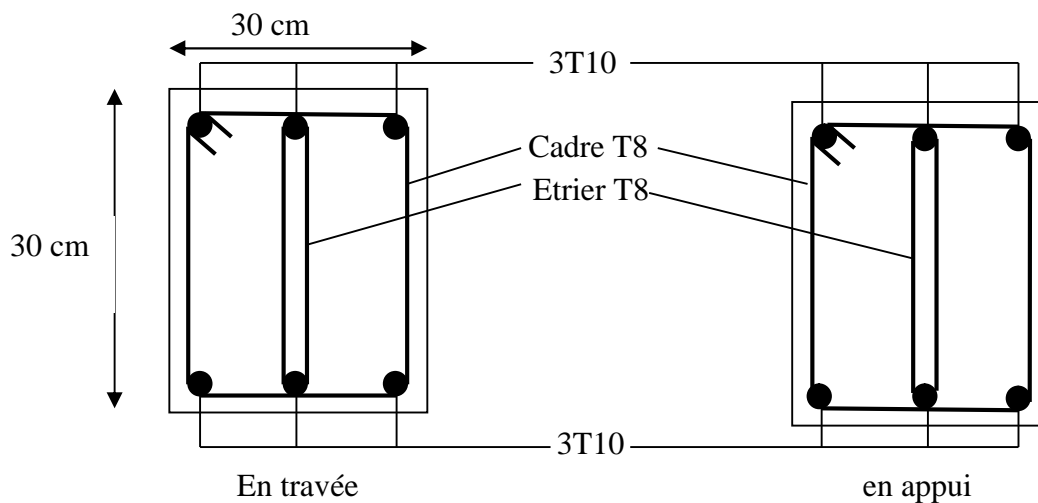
Schéma de ferrailage de la poutre de chaînage
